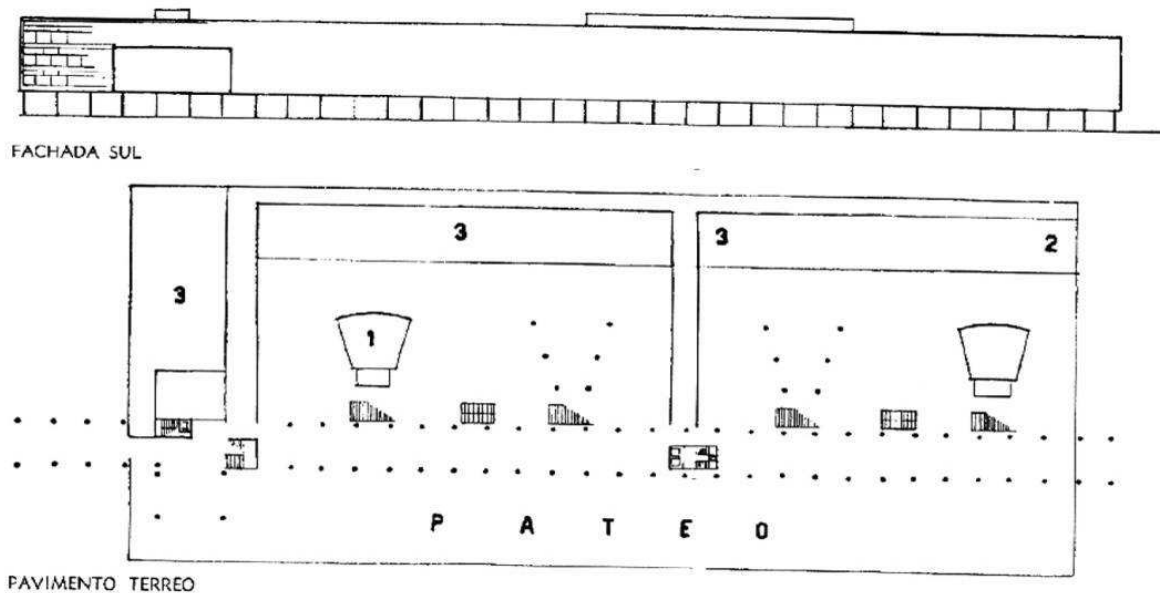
Vista do edifício da escola e planta do térreo (pátio) (COSTA, 1997, p.178)
